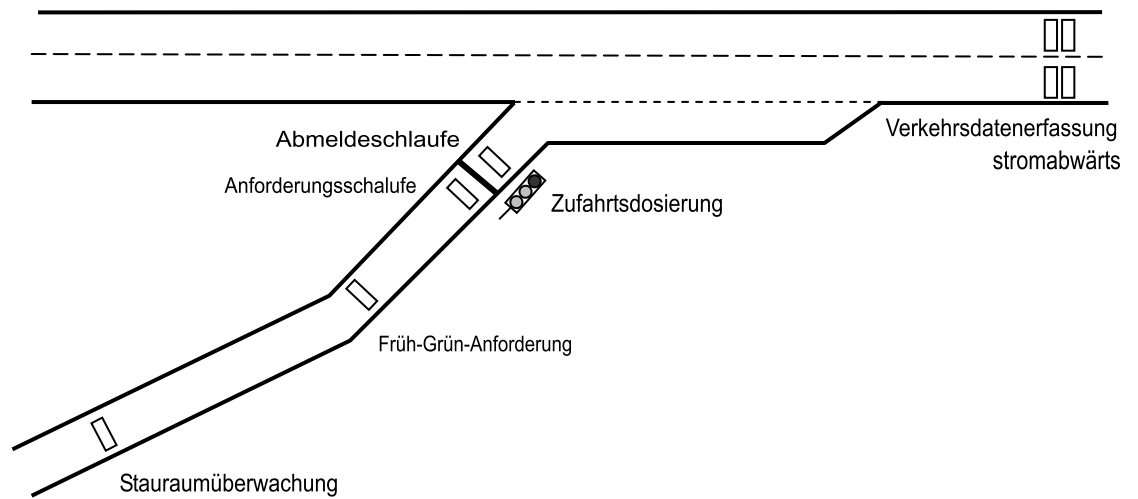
Technische Ausgestaltung einer Rampenbewirtschaftung
